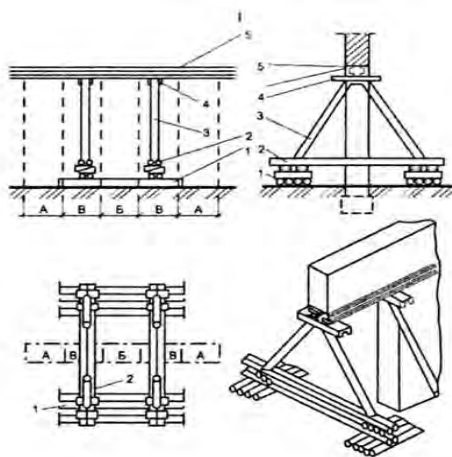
Конструкции креплений при перекладке больших участков стены: 1 – лежни; 2 – затяжка; 3 – стойки; 4 – подкладка под стойки (швеллер или деревянный брус); 5 – металлические балки; А, Б, В – зоны различных нагрузок при трансформации стены
